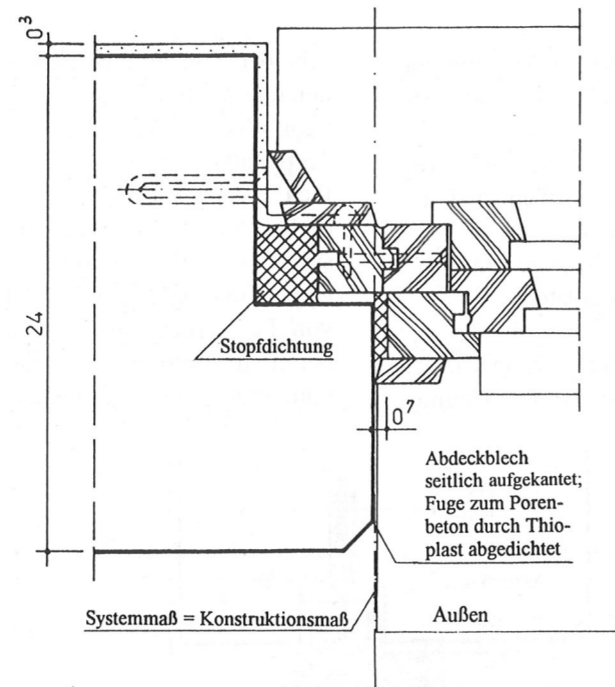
Fensteranschluß bei Außenwänden aus Porenbeton
